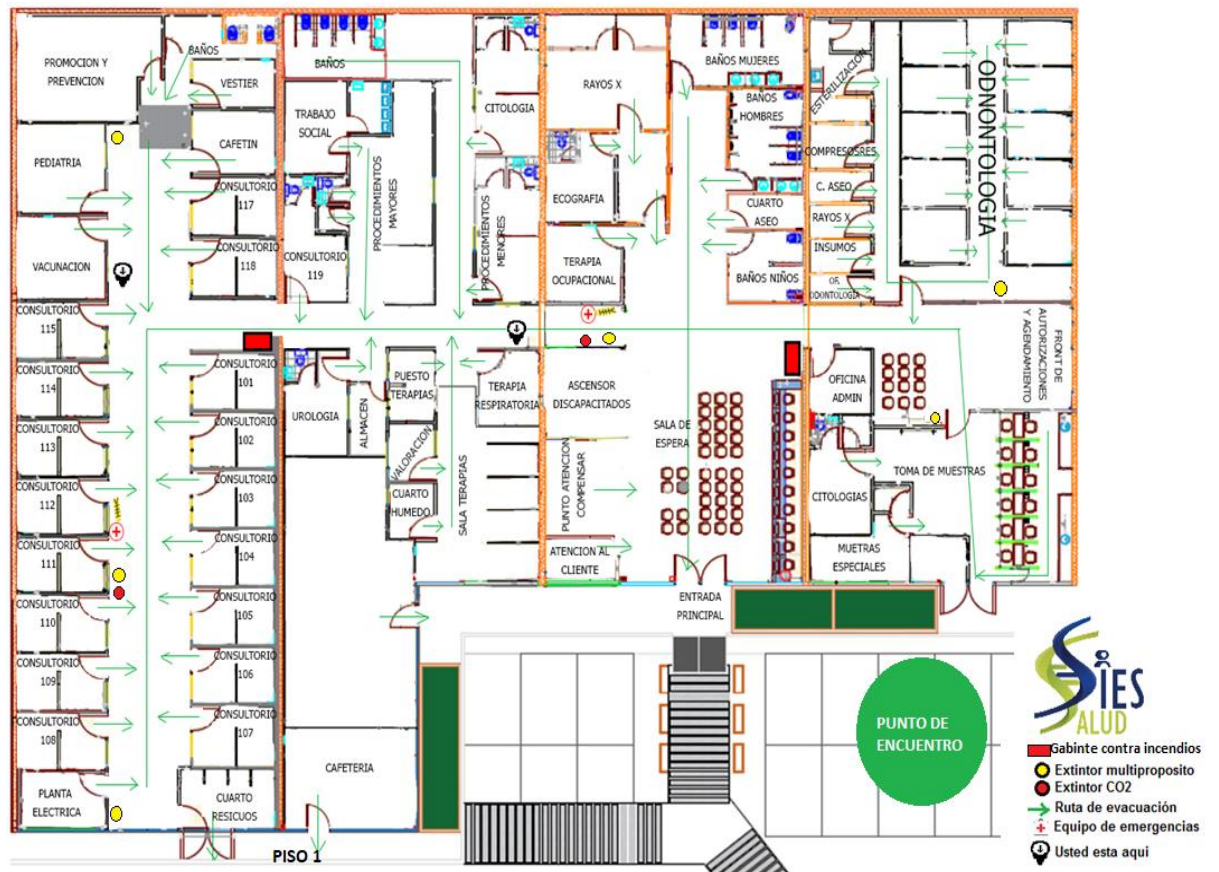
Plano de las instalaciones Fuente: Plan de Emergencia SIES Puente Aranda 2019
